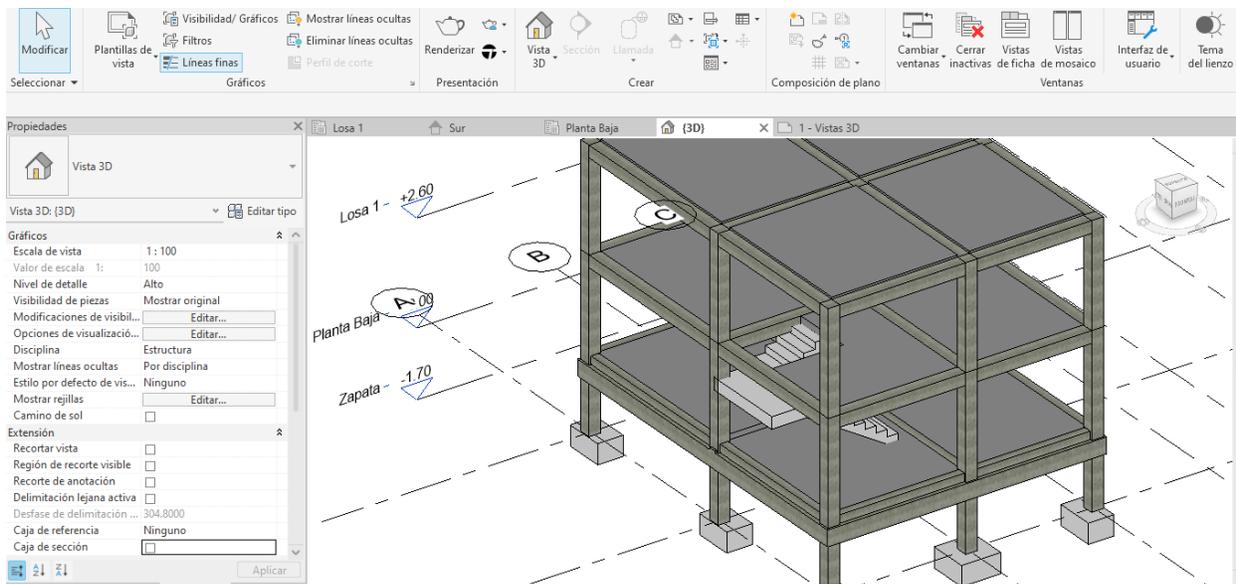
Vista en 3D colocación de la escalera en la estructura
